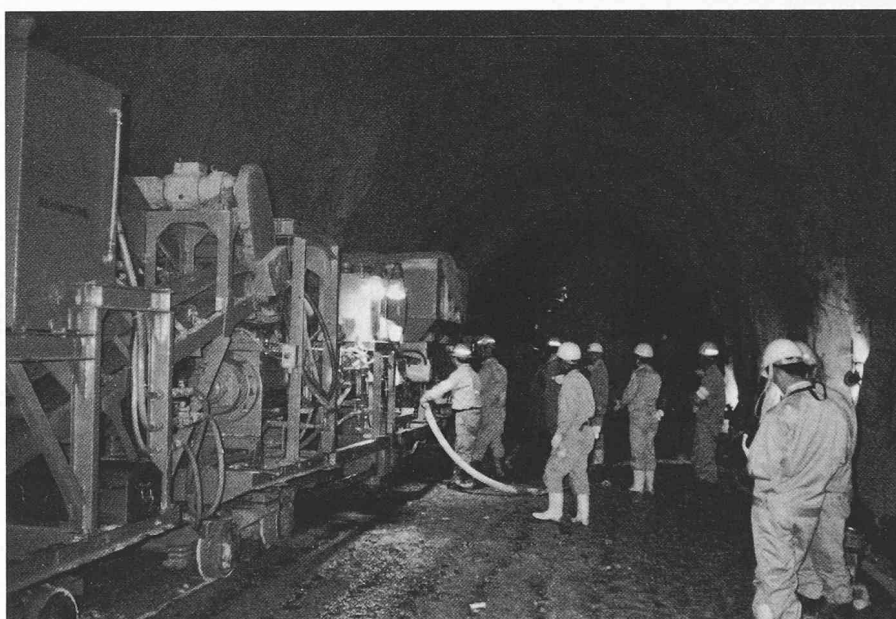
Japanische Tunnelbaustelle. Installation einer 40 m langen Spritzanlage für das Zweiwegverfahren
